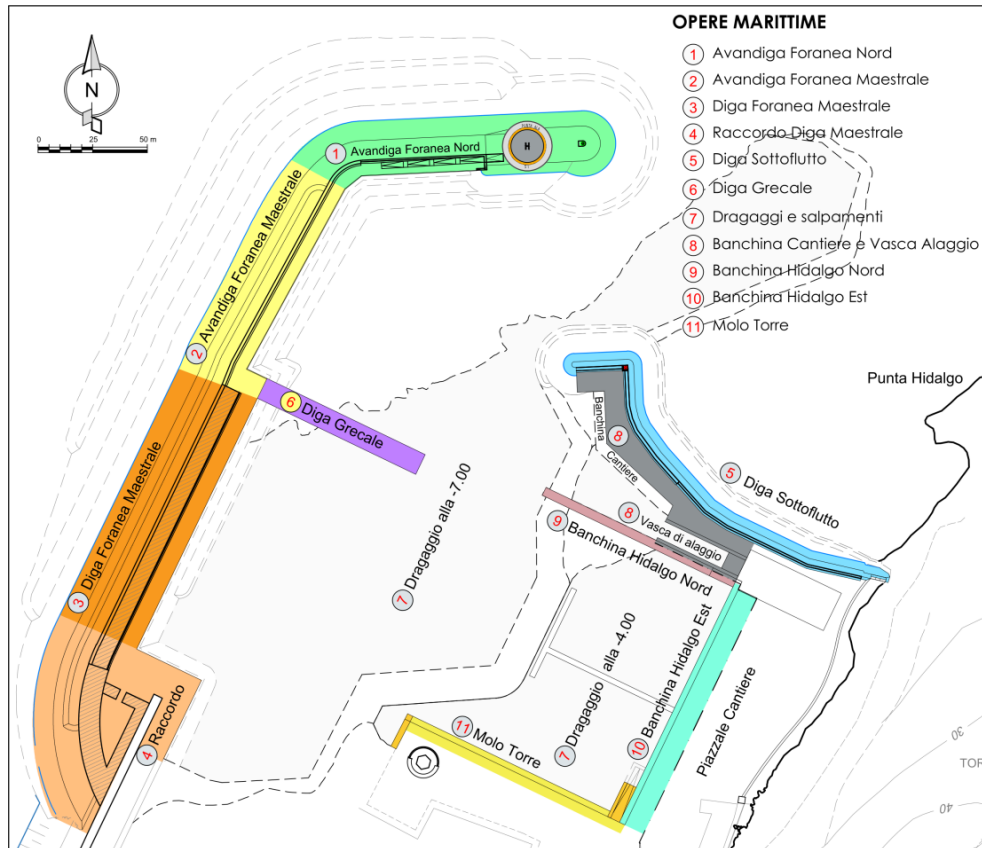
Stralcio della planimetria di progetto con indicazione dei diversi corpi d'opera
